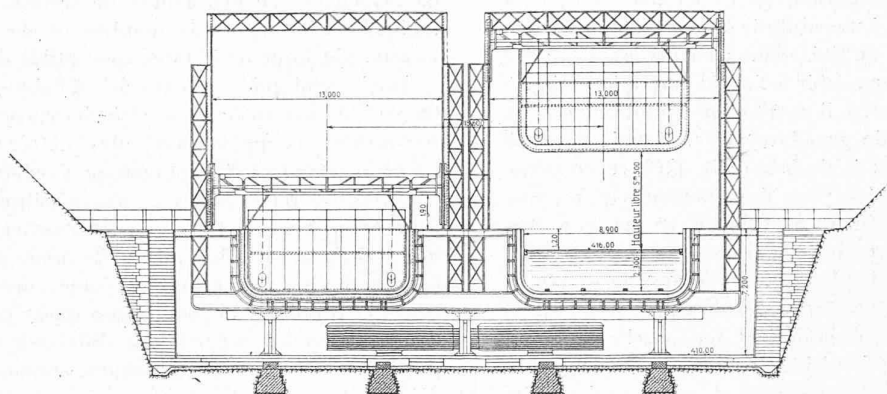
Plans inclinés : installation supérieure. — Vue de face. — 1 : 400.
